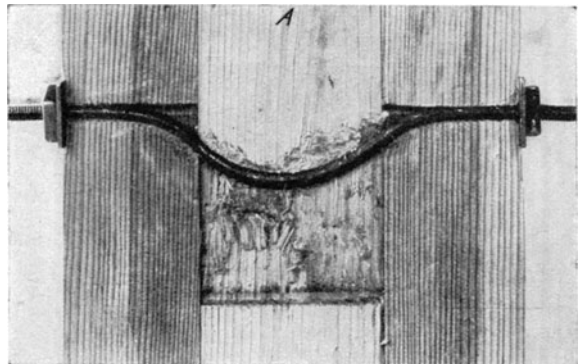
Formänderung eines dünnen Schraubenbolzens. Zerquetschen des Holzes, Eindringen der Unterlegscheiben, Dehnung des Bolzens, Aufreißen des Mittelholzes, Reißen des Bolzens (Zug, nicht Abscheren).
